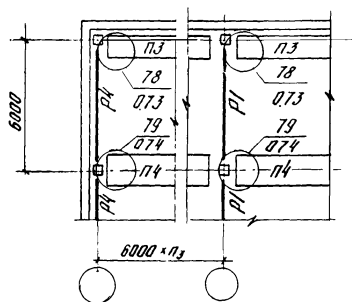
Схема расположения ригелей и связевых плит в перекрытиях зданий с сеткой колонн 6×6 м и $(6+3+6) \times 6$ м
